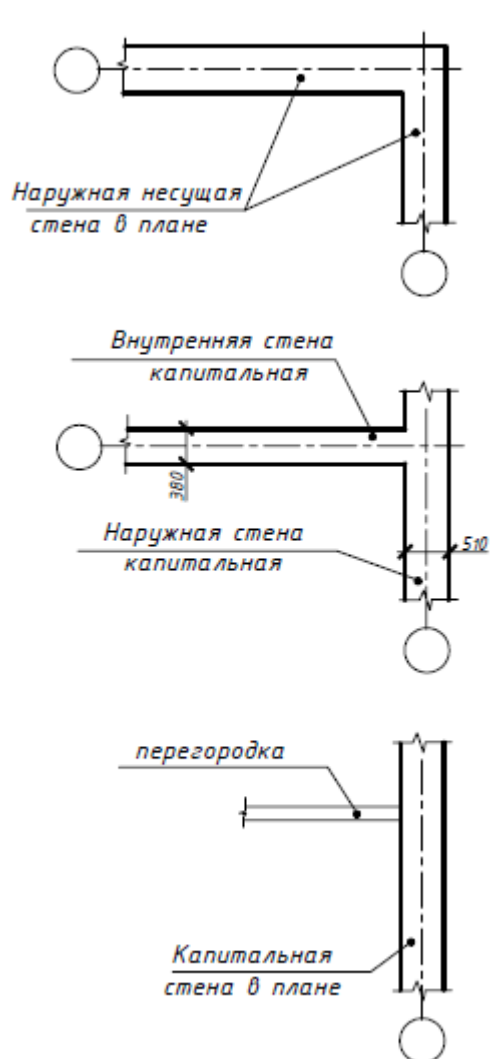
Присоединении наружных и внутренних капитальных стен и капитальных стен и перегородок
